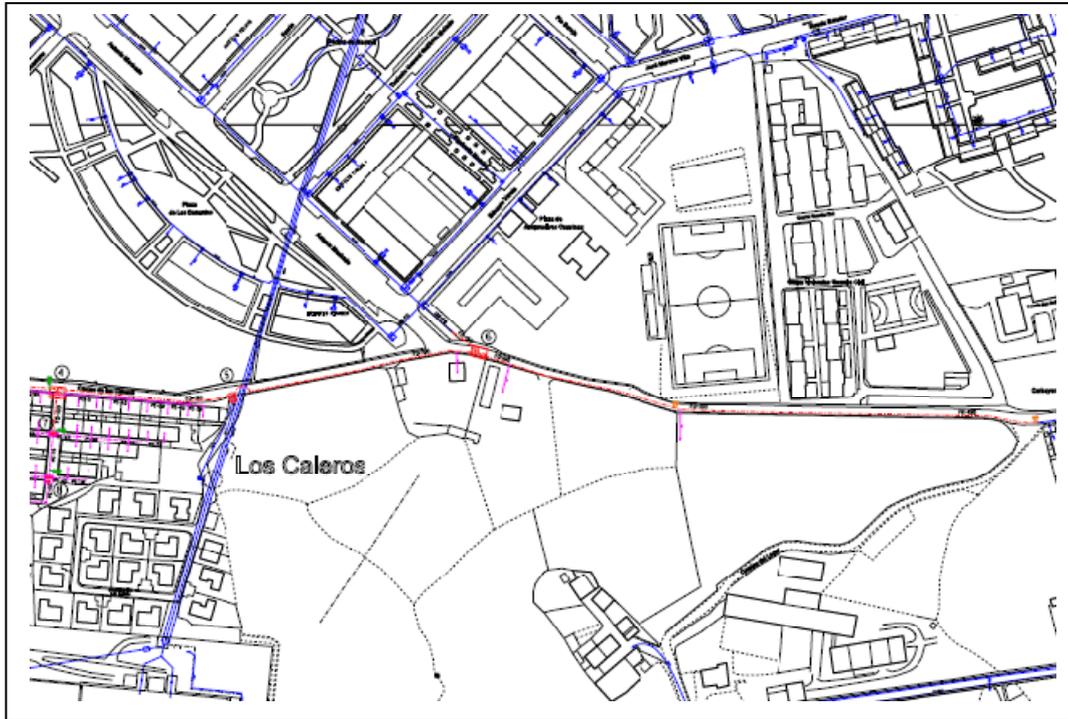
y 8: Tramos de tubería a colocar en rojo, magenta y verde del barrio 1 (zona C). Planos obtenidos del proyecto de ejecución de tubería de agua de la EMA 2009
